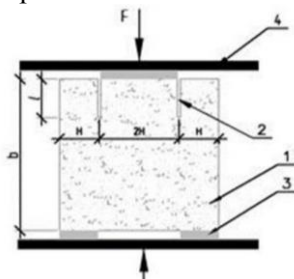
Схема нагружения образца для расчета K_{IC} : 1 – изделие; 2 – надрезы; 3 – металлические пластины; 4 – плиты пресса; b – высота образца, м; H – ширина плеча, м; l – глубина надреза, м, $l = b / 4$; F – нагрузка, действующая на образец в процессе испытания, Н.
